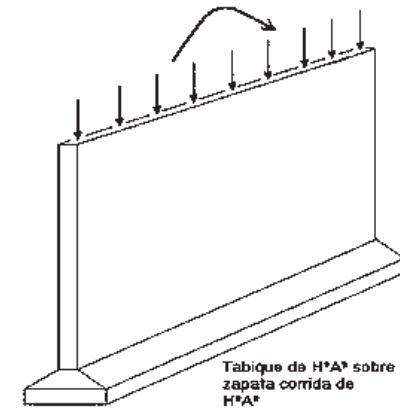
Zapata corrida transmite al terreno las tensiones a las que está sometida el resto de la estructura.
